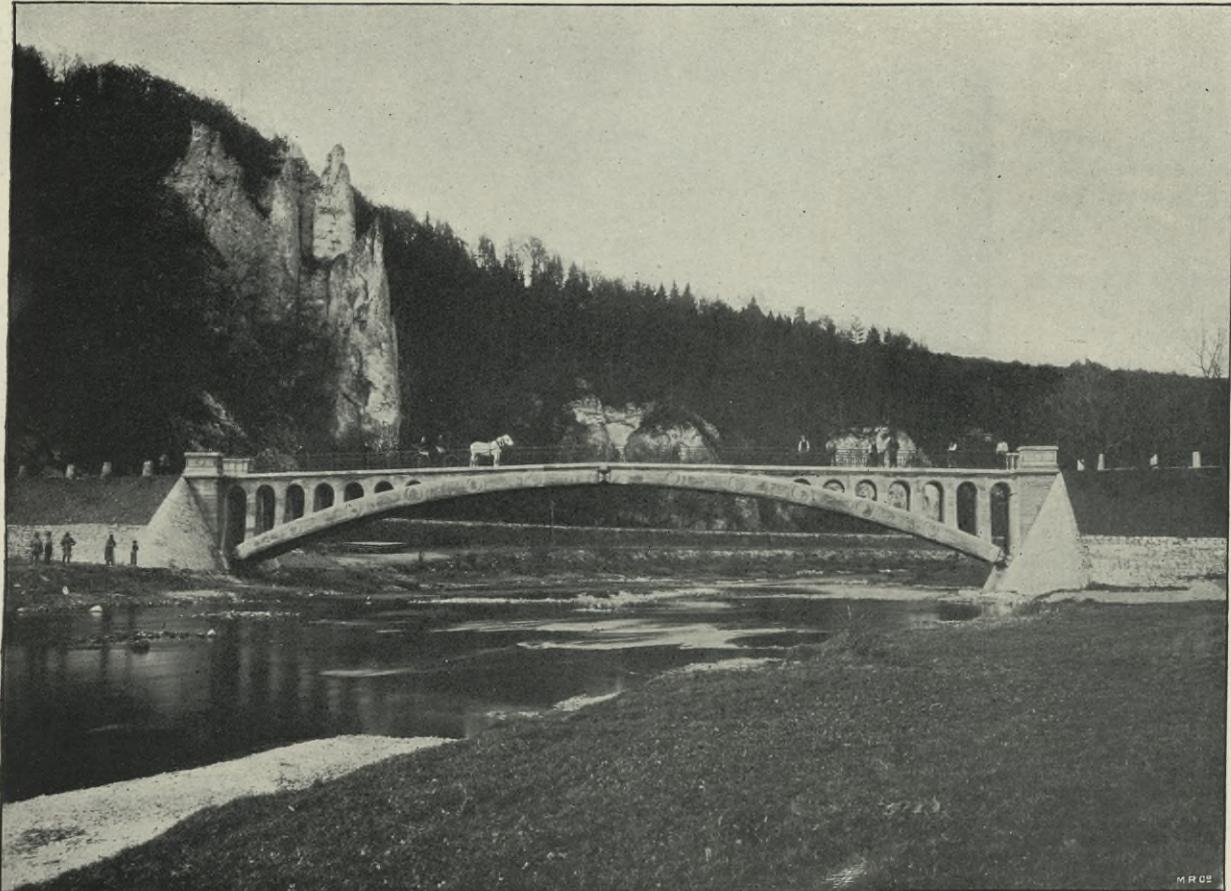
Stampfbeton-Brücke über die Donau bei Inzigkofen.
